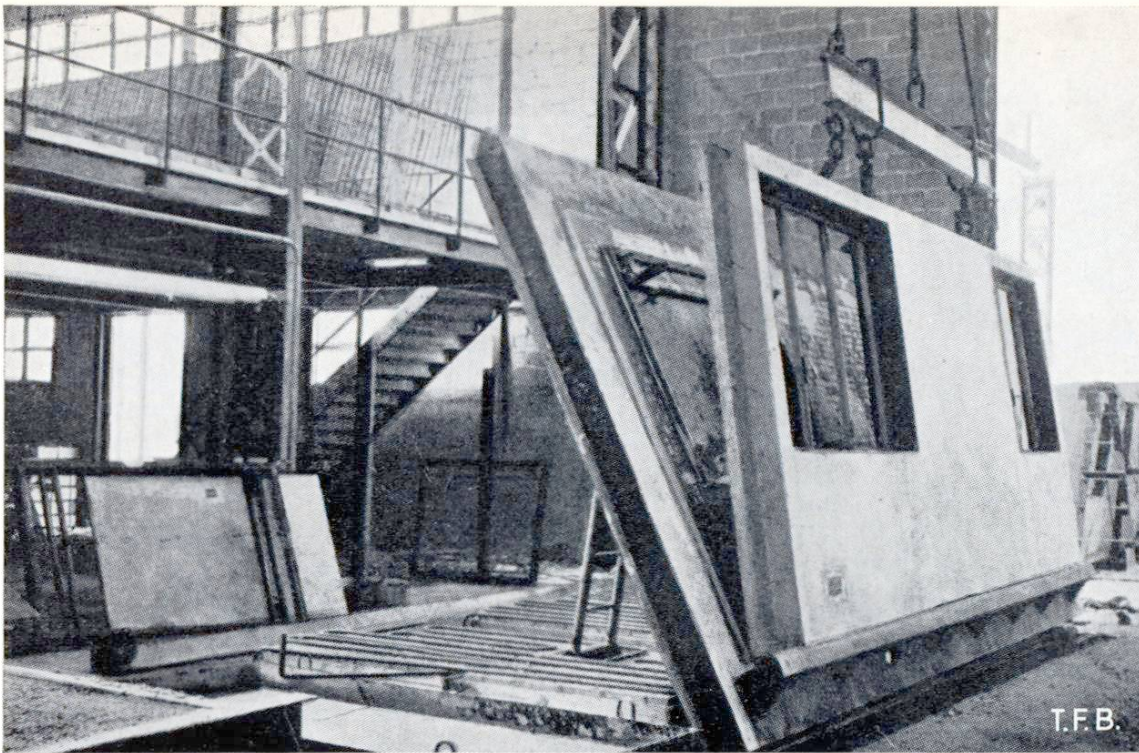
Ausschalen eines horizontal eingebrachten Wandelementes mit eingebauten Fenster-
